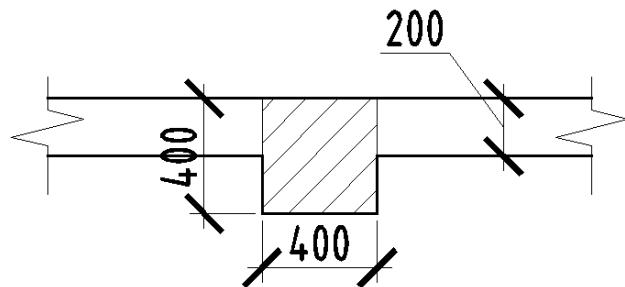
Расчетное сечение главной балки при расчете на отрицательный изгибающий момент
